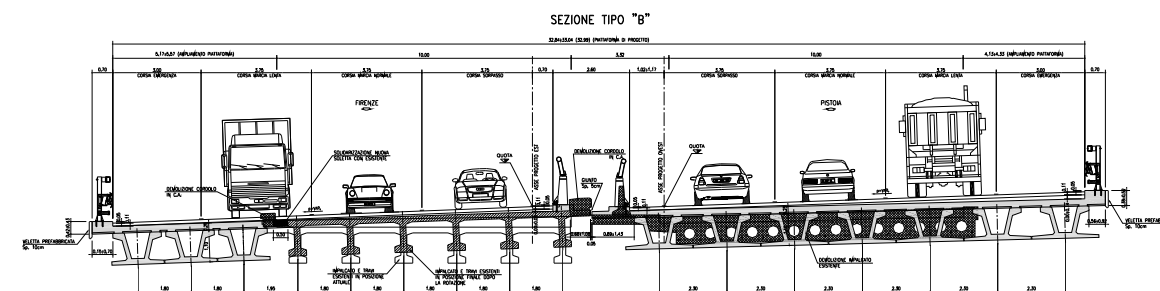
Sezioni impalcato in ampliamento su pile spalle.
